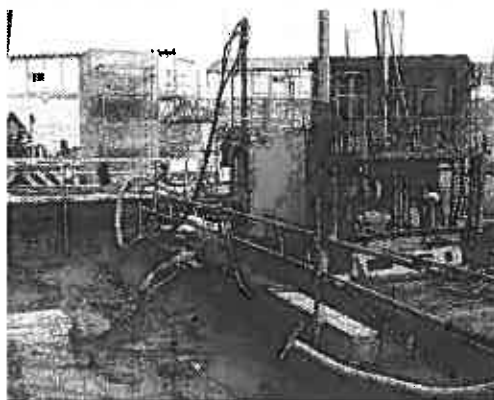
高圧噴射攪拌工法の汚泥の発生状況
